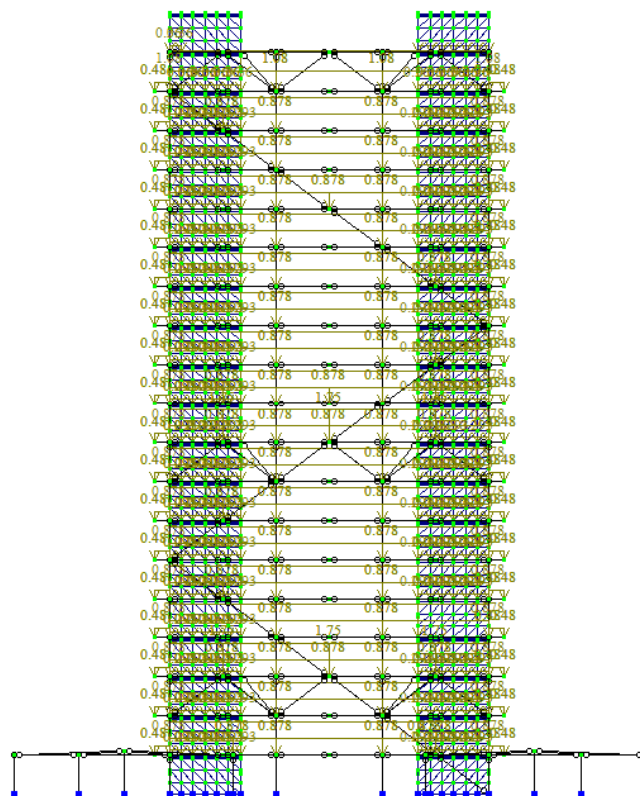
,11.44. и 11.45. Полезная нагрузка на перекрытие (продольный разрез)
